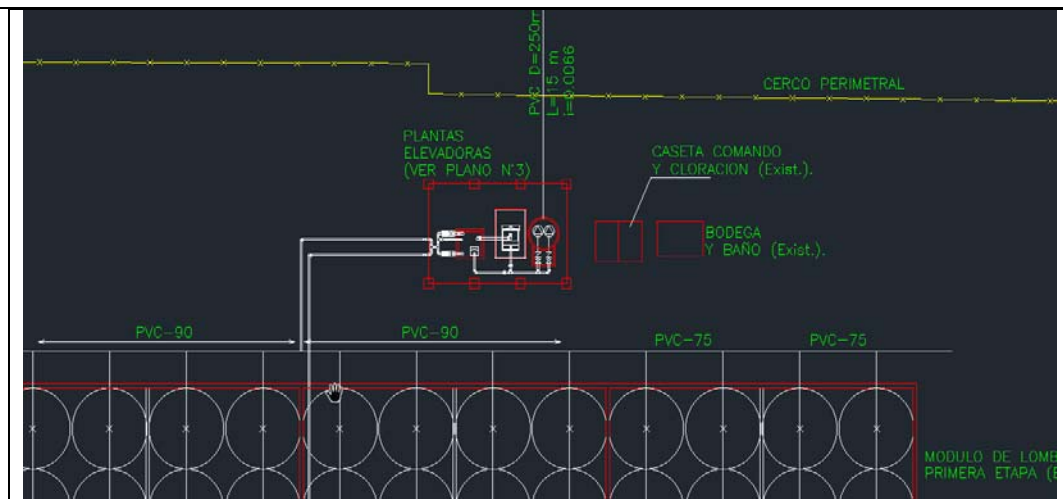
Ubicación de Plantas elevadoras y filtro parabólico dentro del proyecto de tratamiento PTAS San Ramon
